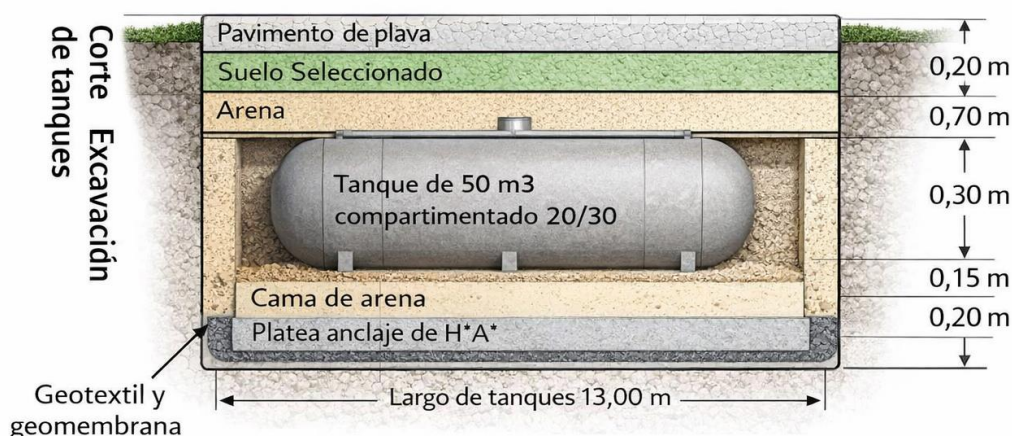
Corte esquemático de la excavación e instalación de los tanques
